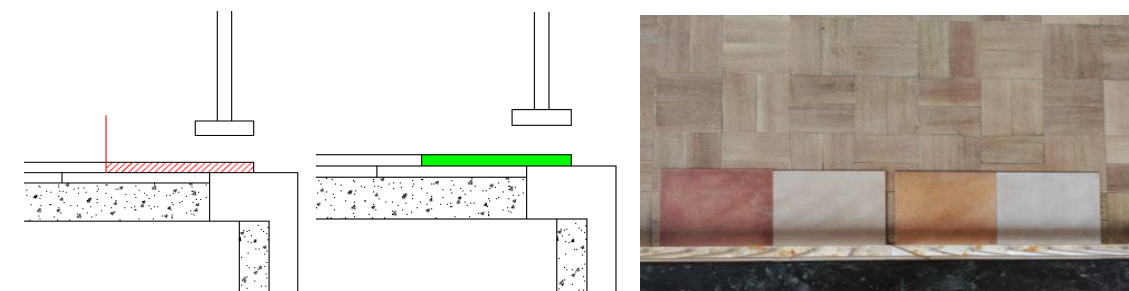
Actuación prevista y prueba de posibles piezas de remate
